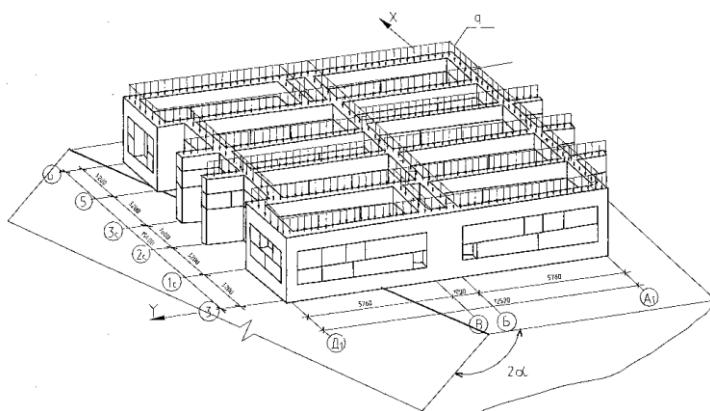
Сборно-монолитный железобетонный фундамент в виде системы перекрестных балок на упругом клиновидном основании
